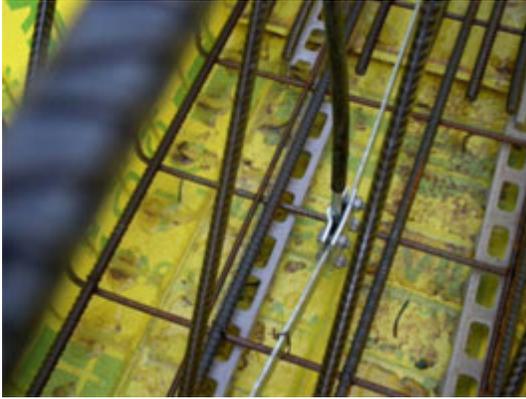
Anschlussfahne mit ummantelter Stahlleitung zum Korrosionsschutz
